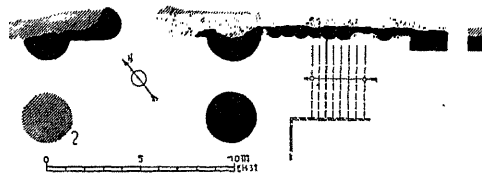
Grundriß der »Hohen Pforte«, Ergänzungsversuch.
